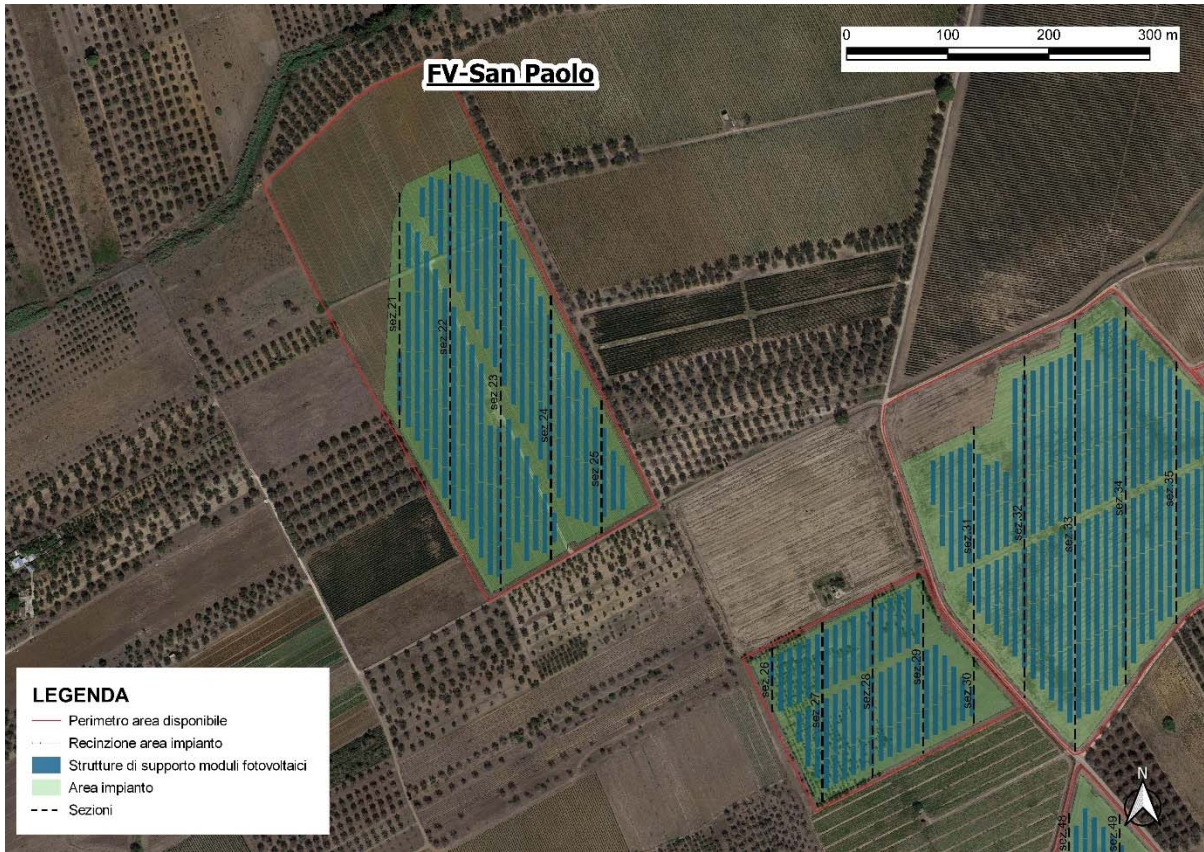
Sezioni sul sito di installazione FV- San Paolo
